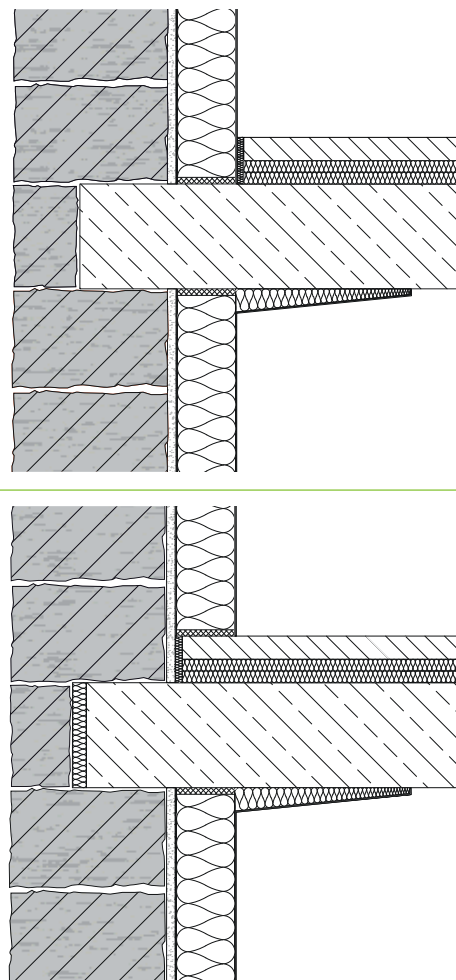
Fußpunktausbildung eines Innendämm-Systems auf der Rohbetondecke bzw. auf dem schwimmenden Estrich
